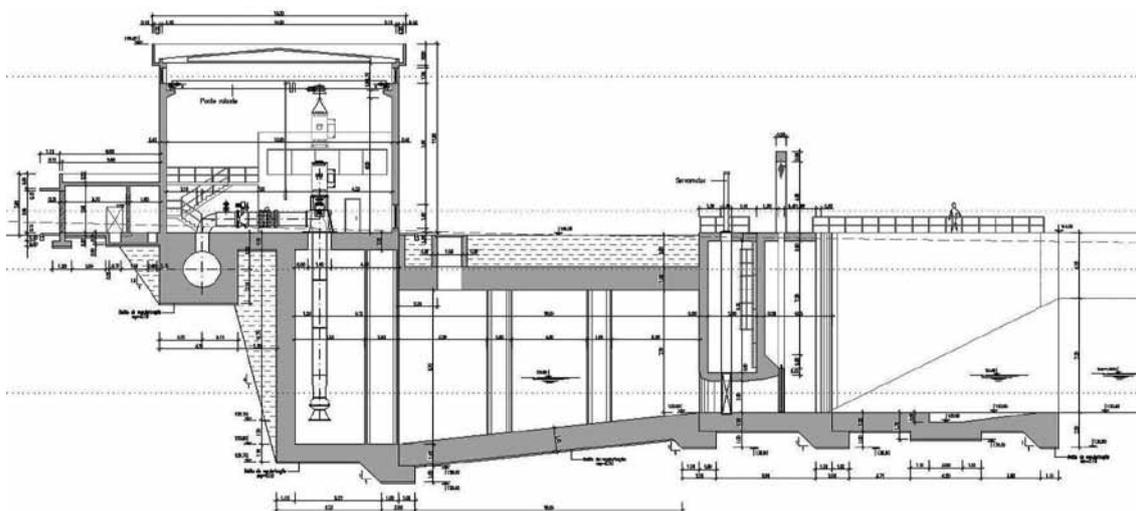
Estação Elevatória de S. Pedro. Corte longitudinal
